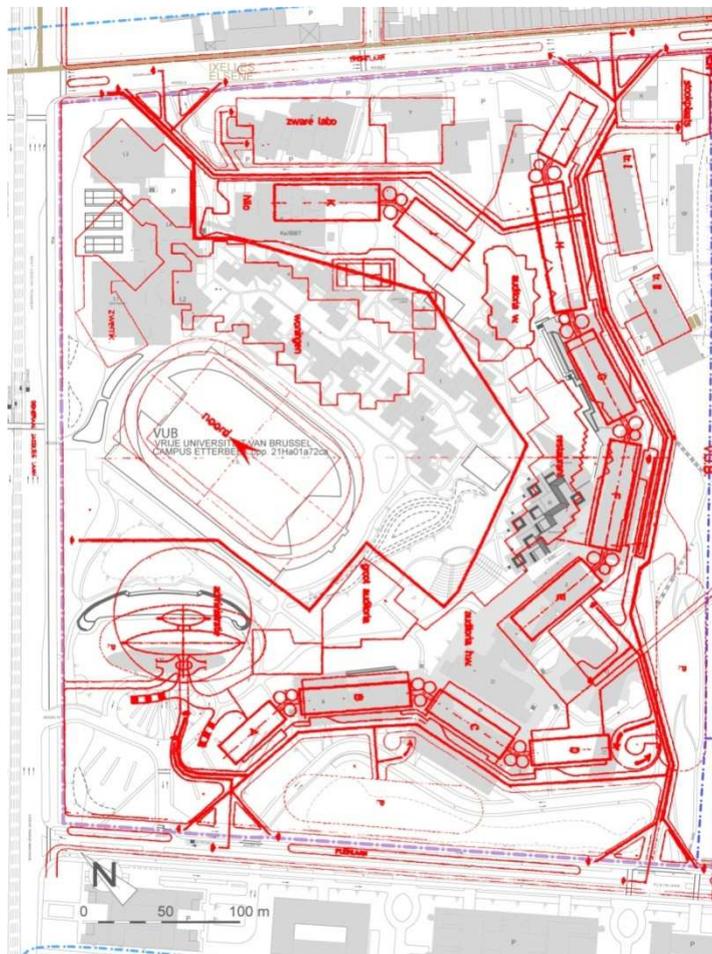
Superposition des plans « Le Maresquier », en fond de plan situation actuelle
